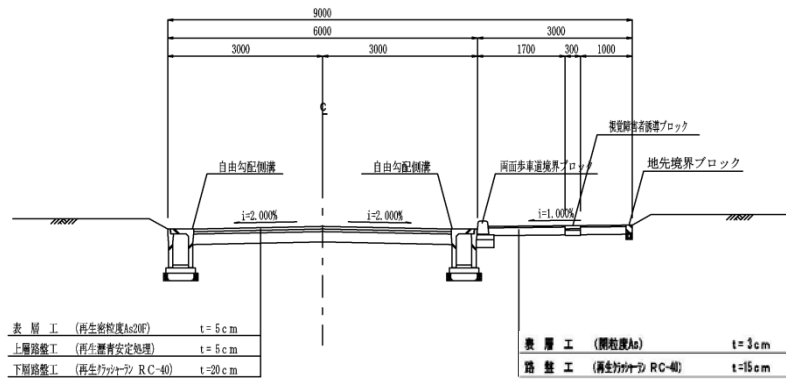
(5) 道路断面図(主要区画道路:9m 標準断面)
